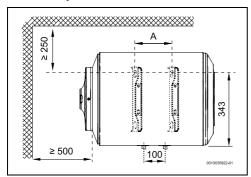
Dimensões em mm (montagem mural, instalação horizontal, TR1000...H)
